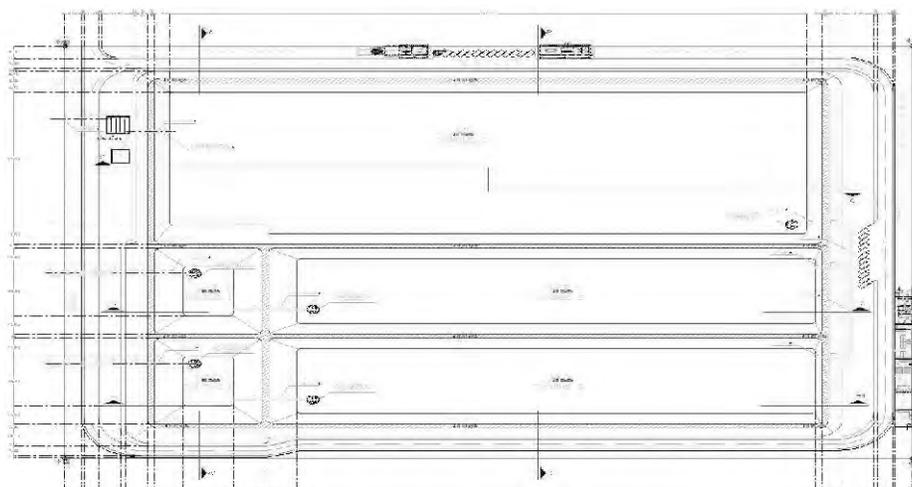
Vista en planta del sistema de lagunas de estabilización.
